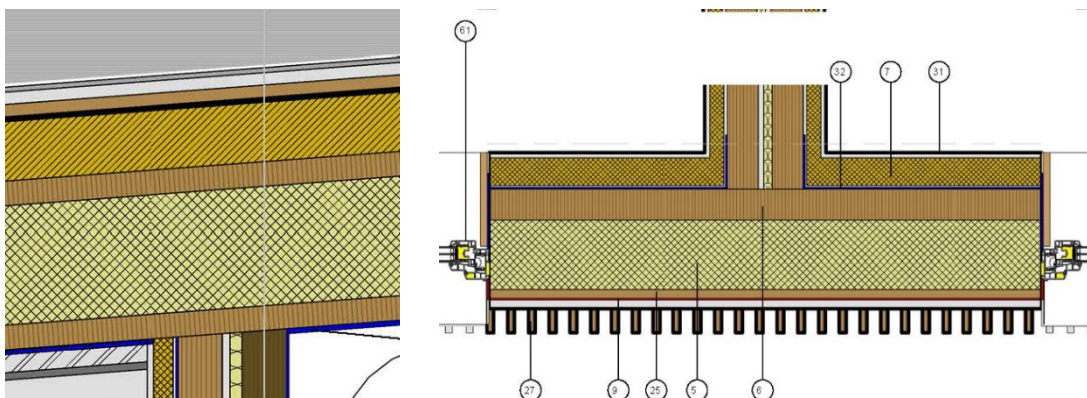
Detalle constructivo de cubierta (izq.) y Figura 5. Sección constructiva de la envolvente térmica y la envolvente de estanqueidad continuas (dcha).
